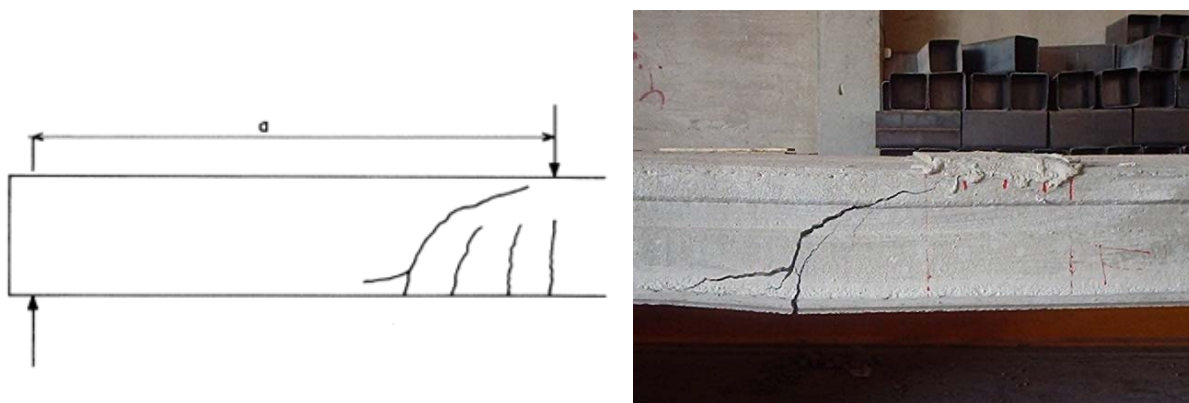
Interação de fissuras de cisalhamento com fissuras de flexão em ensaio de flexão de uma laje de 200 mm com três metros de vão.
